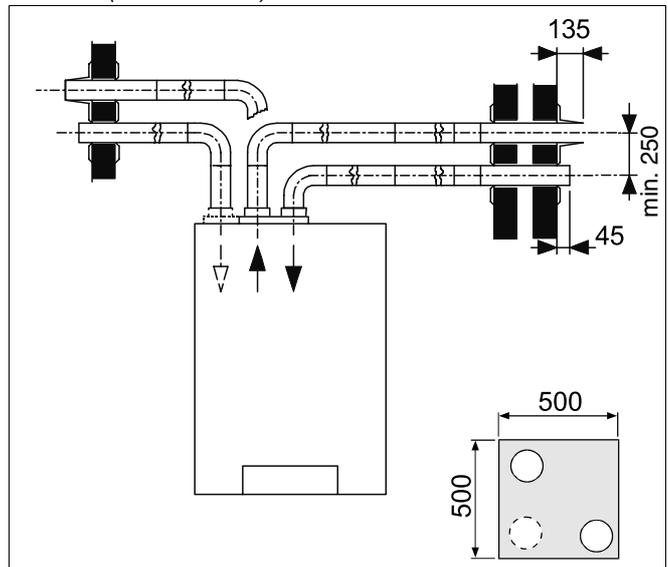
Diretta alimentazione d'aria attraverso la parete esterna e scarico dei fumi attraverso la medesima parete esterna (misure in mm)
